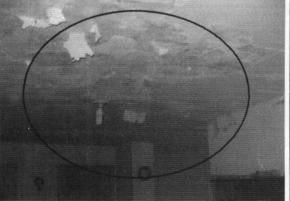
Humedad y desprendimientos de acabados bajo la placa de cubierta
